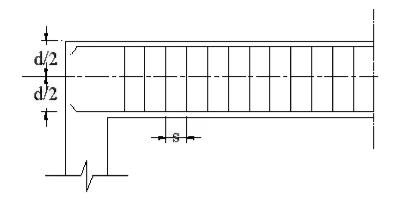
توزيع الكانات المائلة في كمرة بسيطة
